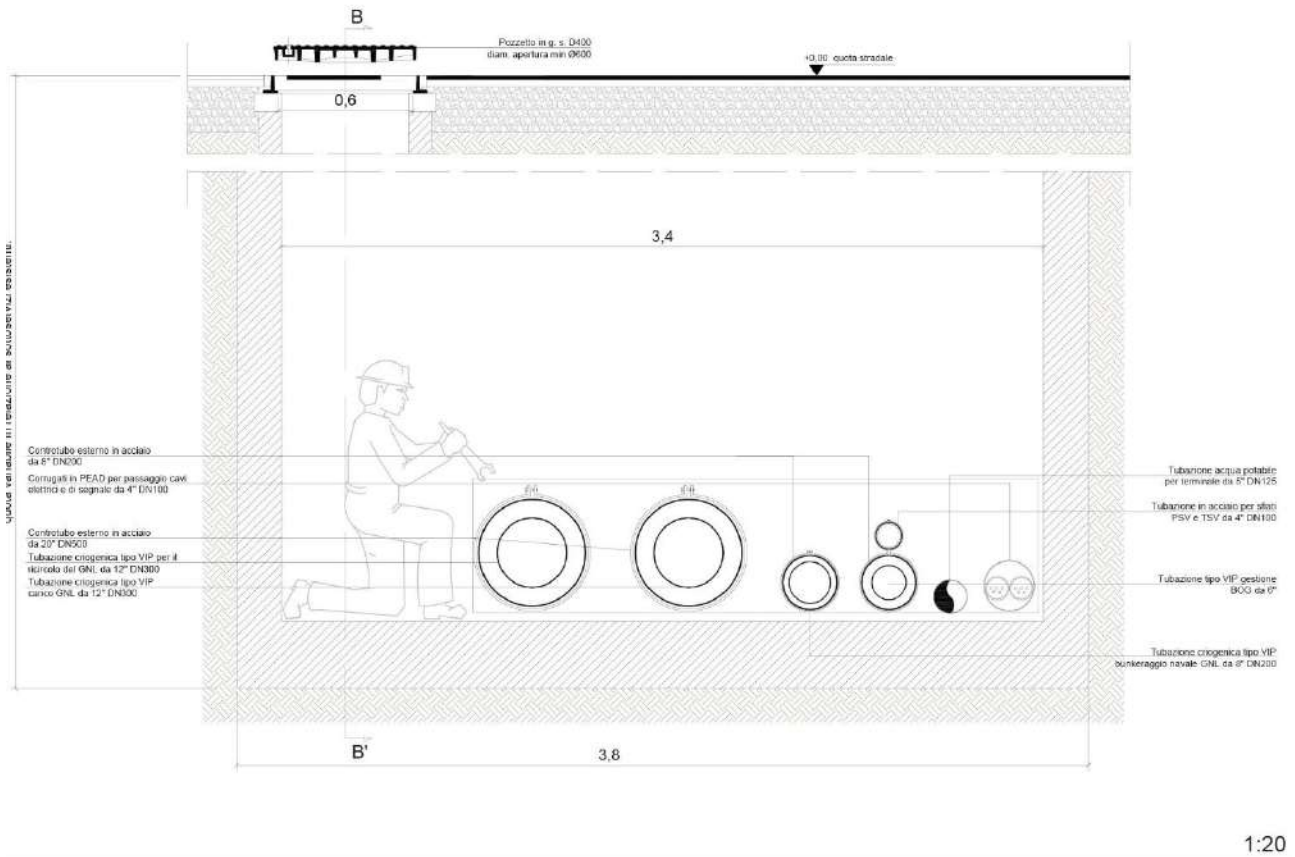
Sezione trasversale sul pozzetto di ispezione
